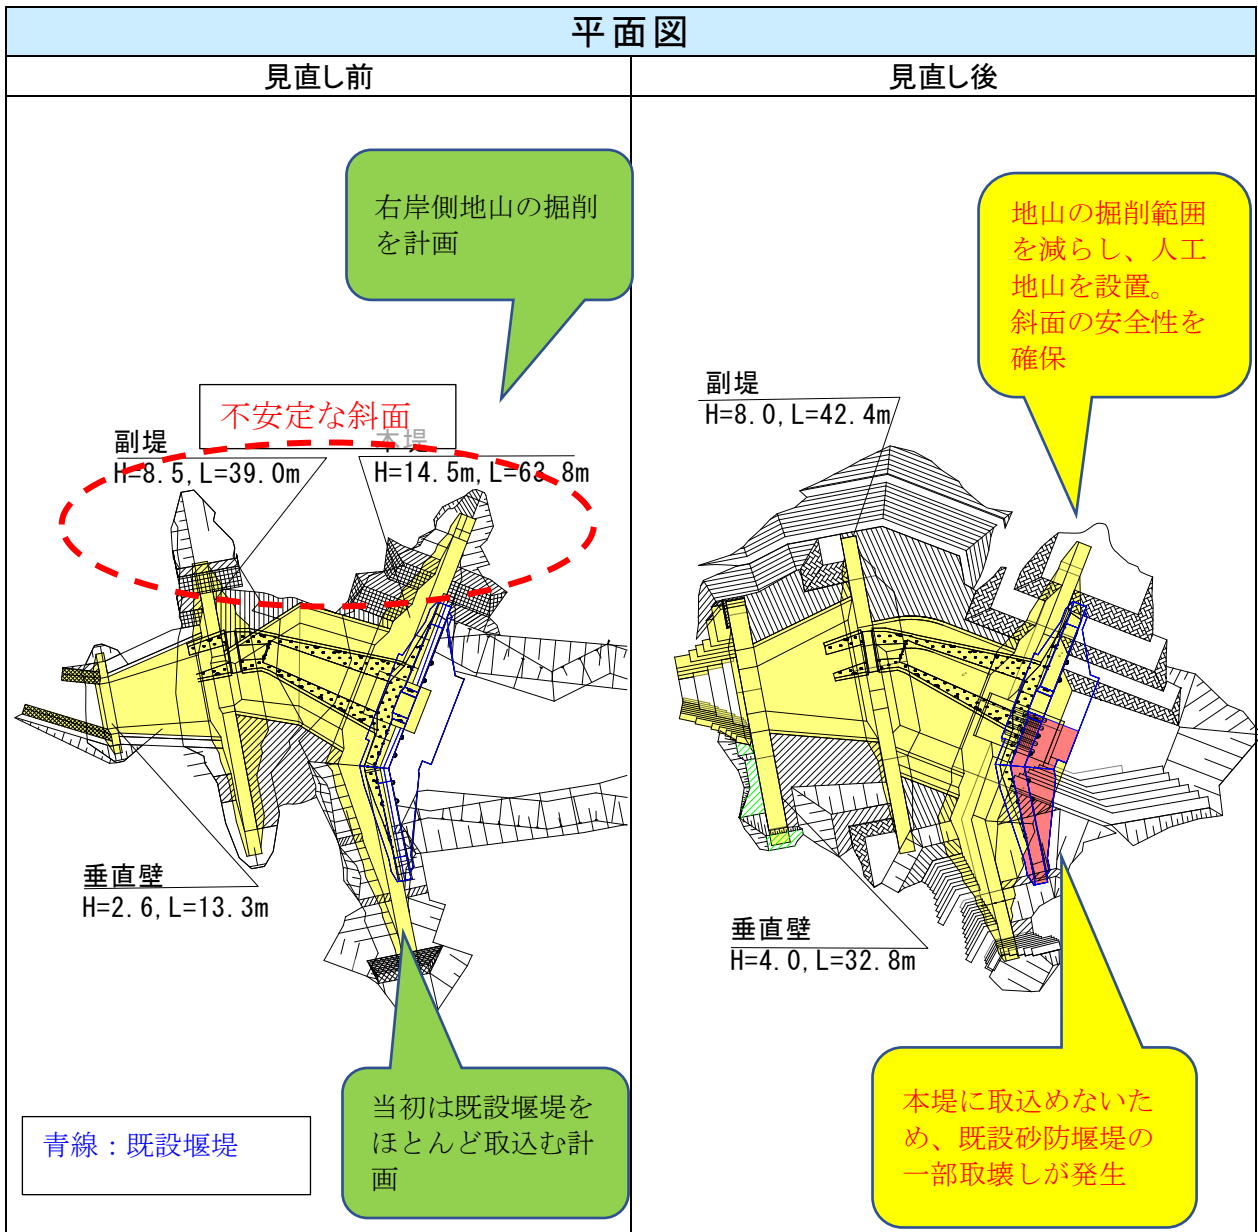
本川砂防堰堤位置変更による構造見直し（平面図）
